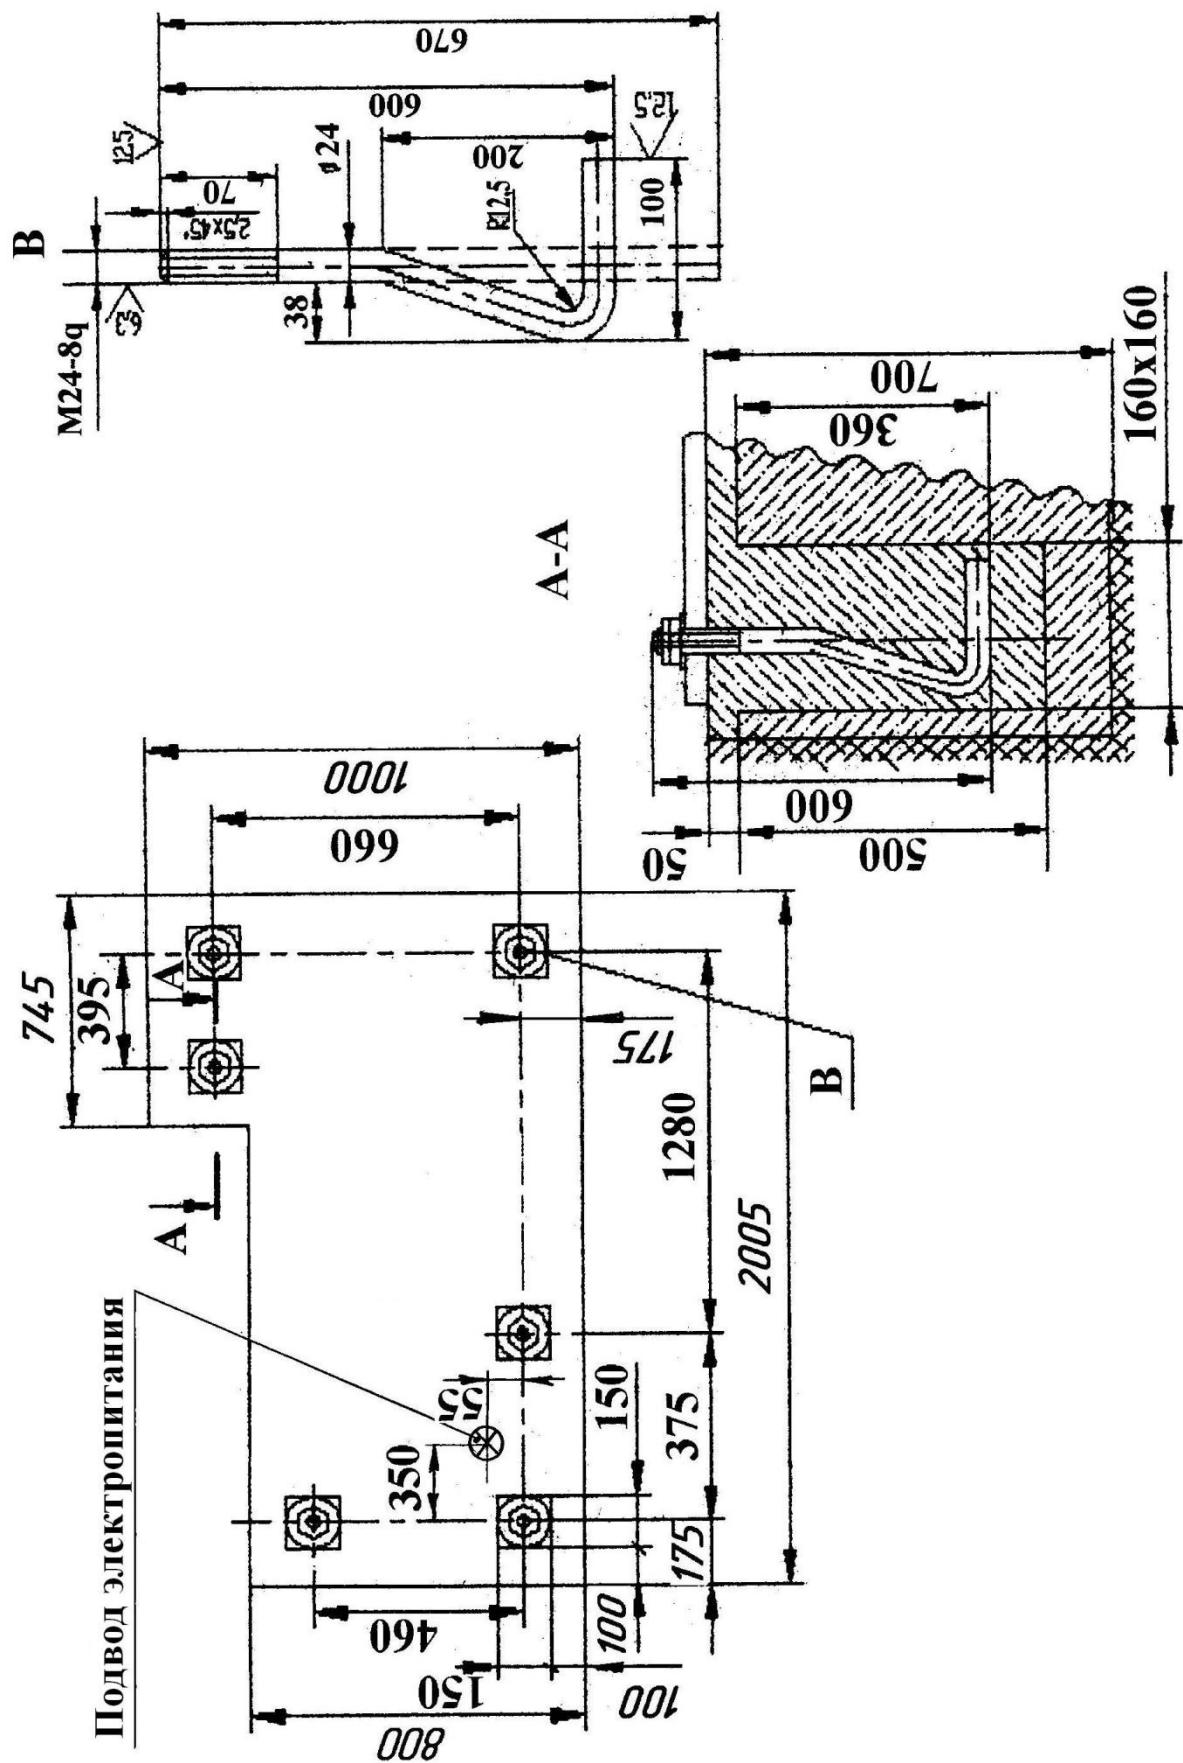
Схема установки пресс-ножниц НГ5224 на фундамент
